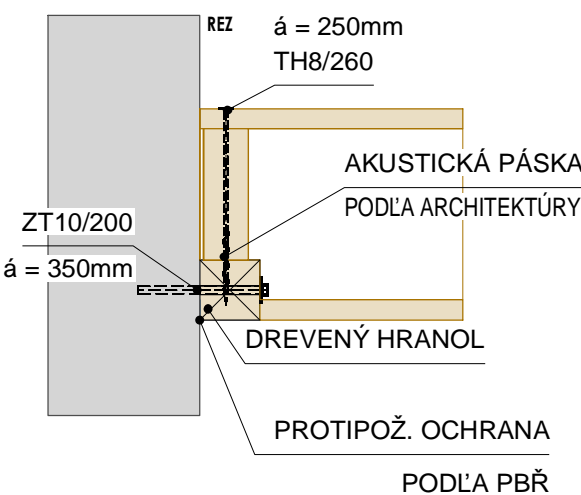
DETAIL "G" - PRIPOJENIE STROPNÉHO PANELU A BETÓNOVÉHO JADRA
